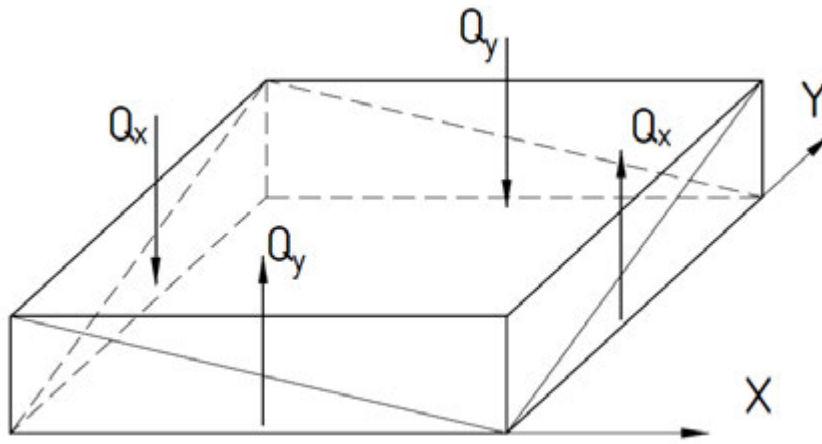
Схема зусиль при розрахунку на дію поперечної сили
